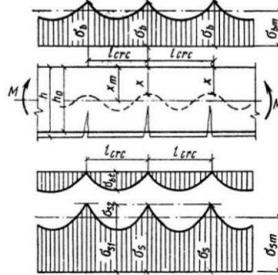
Эпюра напряжений традиционных железобетонных конструкций
